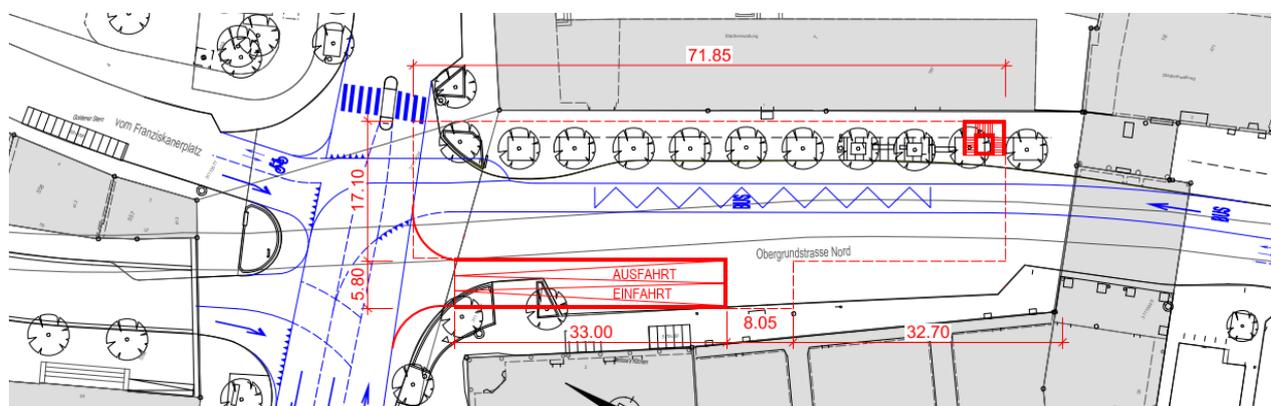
Ausschnitt Situation Variante Obergrund 1.2 Oberfläche
